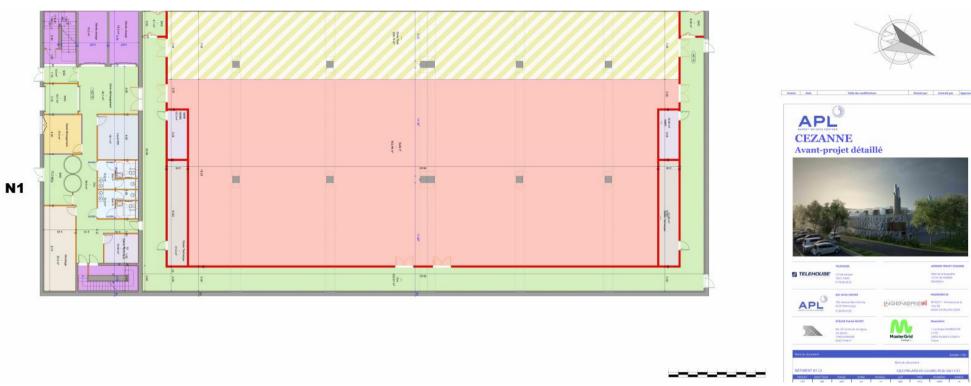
Plan étage RDC d'un bâtiment datacenter
